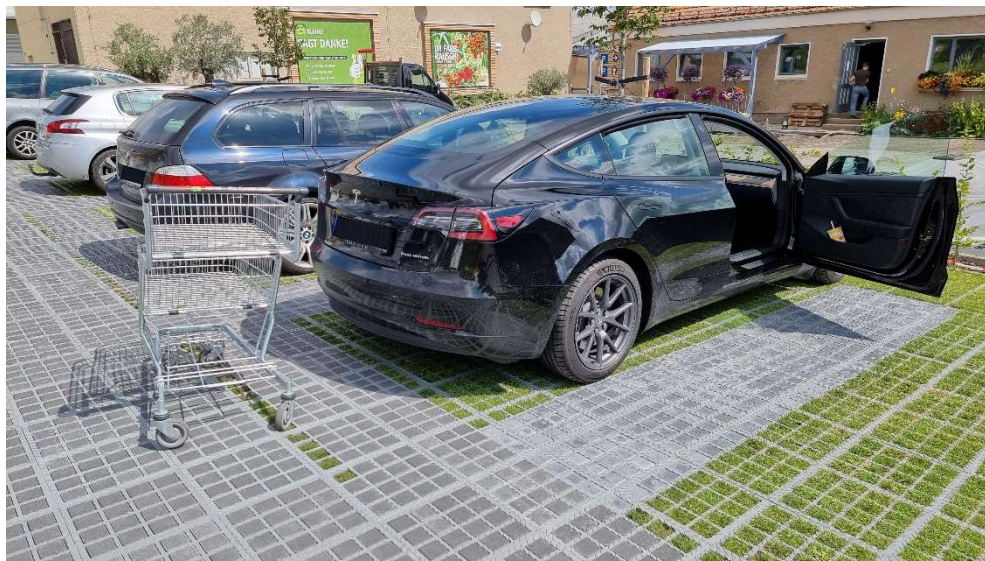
Modelo de pavimento permeable (Hübner-Lee, 2022)
